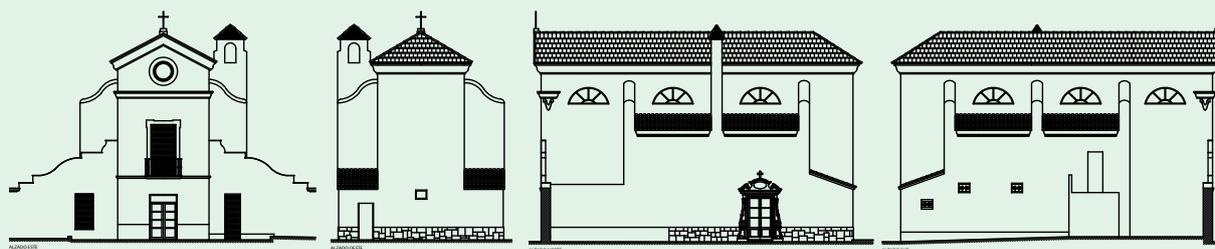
Alzados de la ermita actual del Cementerio Viejo de Elche
